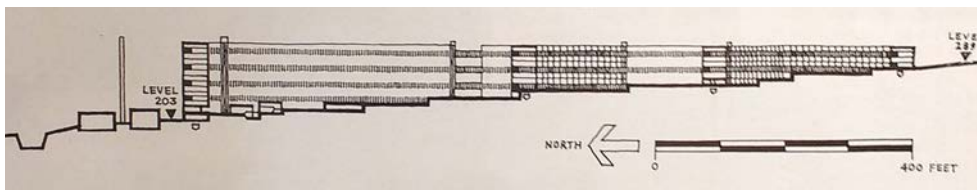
Sección de Park Hill con las cotas del terreno. En *Architectural Design* en 1961.
